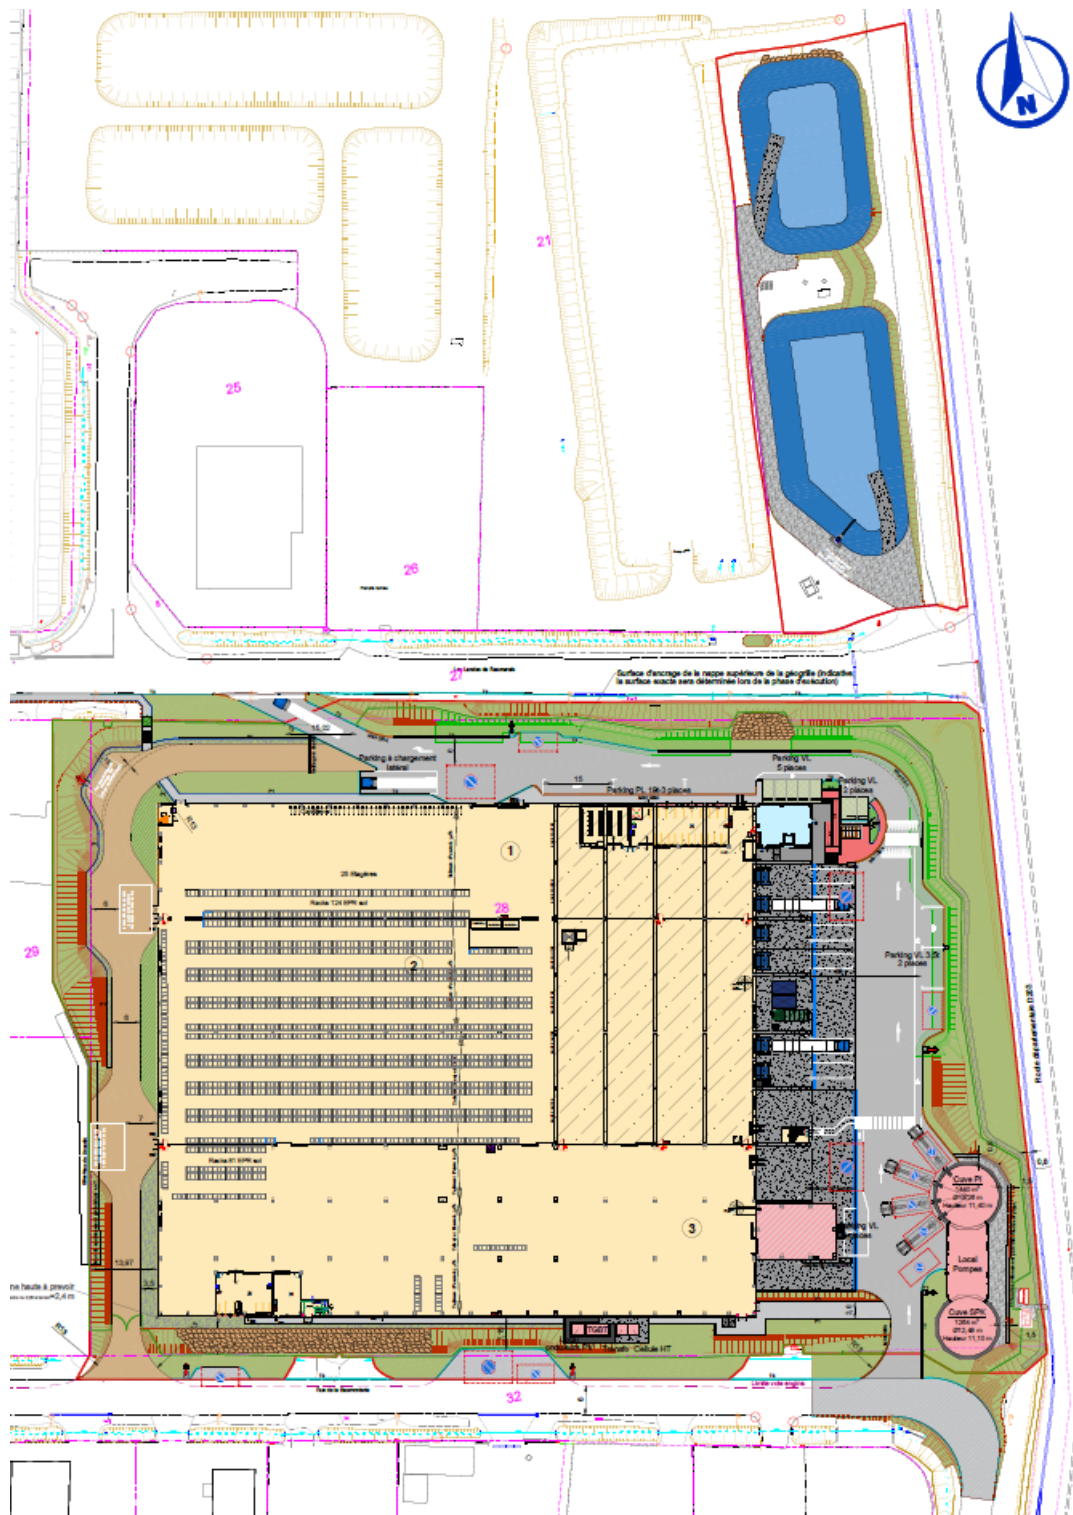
Plan d'implantation de l'entrepôt projeté (source Plan de Masse indice Q du 22/01/2026)
